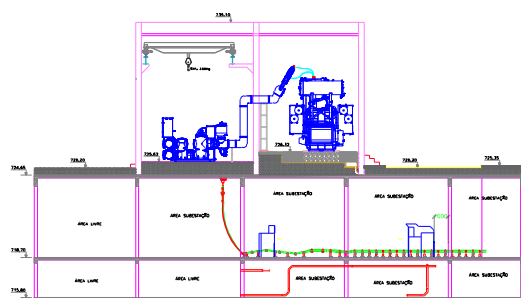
Corte da subestação utilizando 1º e 2º subsolo.
